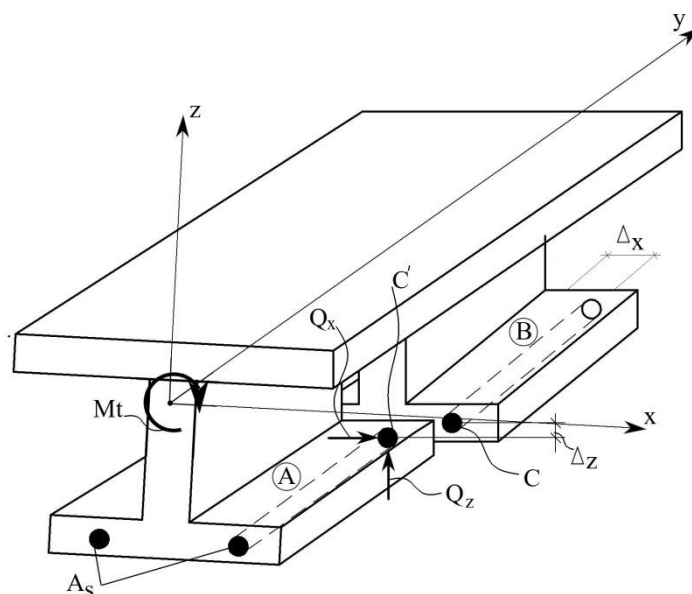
Схема переміщень в перерізі з нормальною тріщиною і зусиль в поздовжній арматурі елемента, на який діє крутний момент
